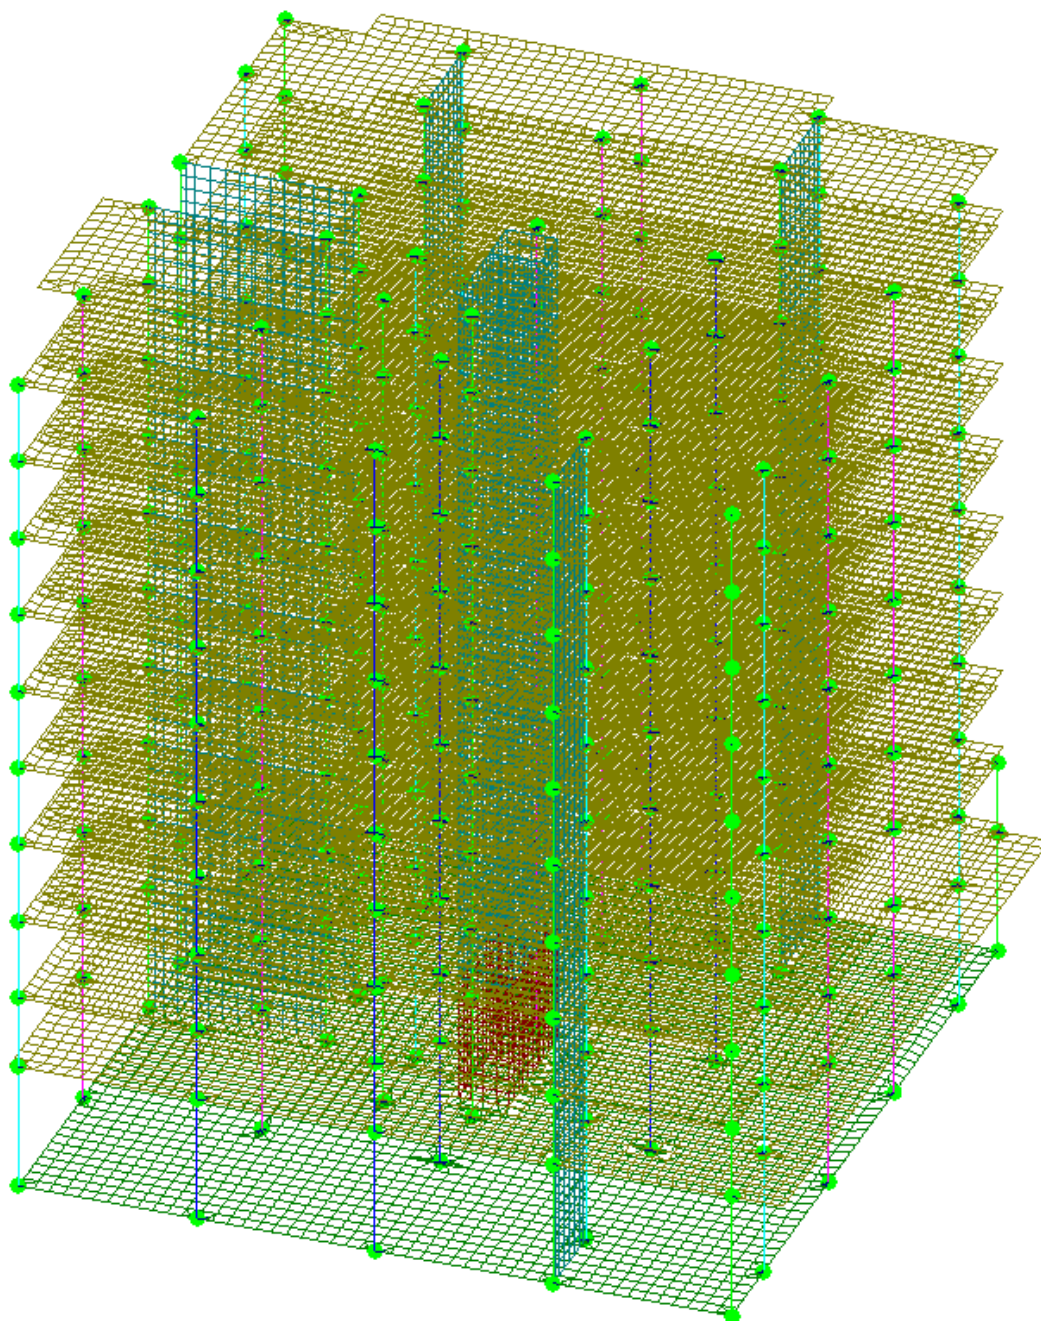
Расчетная схема здания в «SCAD»
